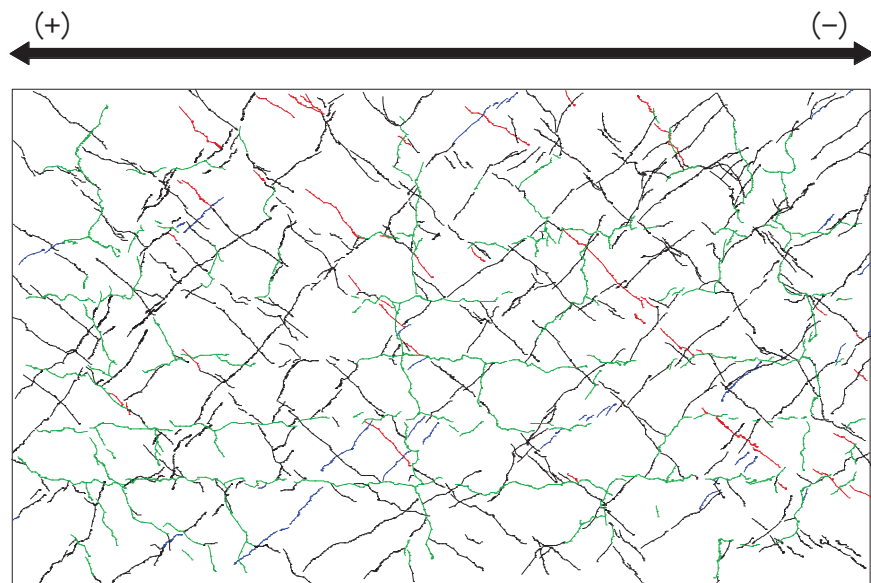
(10) 乾燥試験体 [2] 1/333rad. におけるひび割れ図
